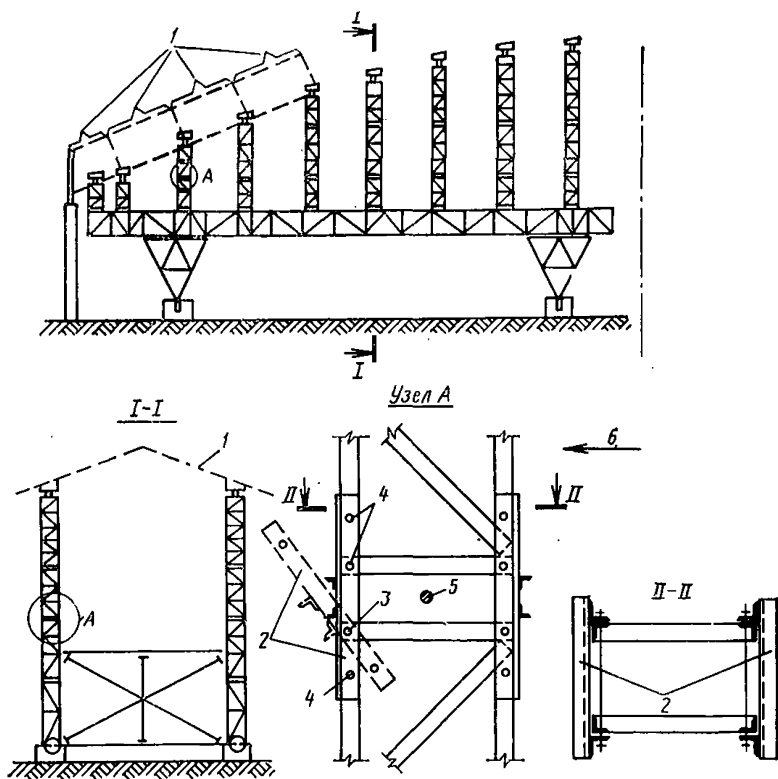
Схема инвентарного передвижного кондуктора для монтажа свода
